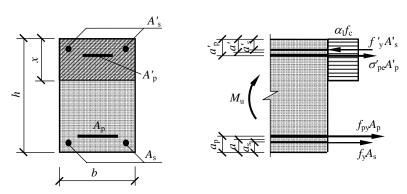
矩形截面预应力混凝土受弯构件正截面承载力计算
